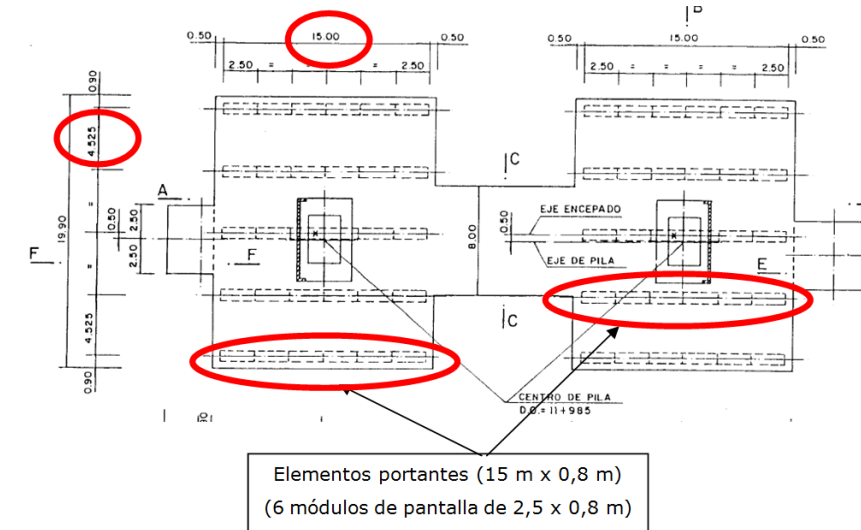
Planta de la cimentación del pilono P-14 (copiada del Proyecto Modificado n° 1)
